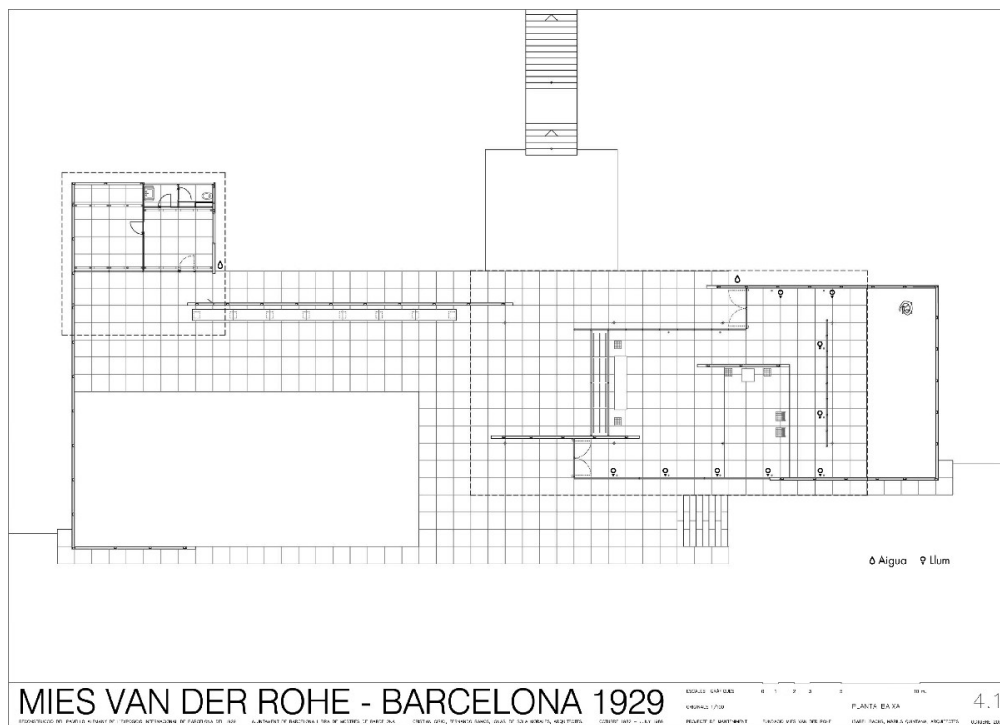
Plano de planta del Pabellón de Barcelona (Zeballos, 2010)
